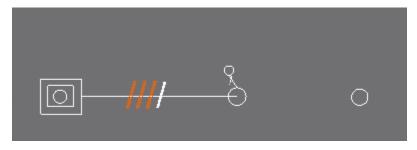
Plano de distribución del cableado eléctrico. (Autor)
